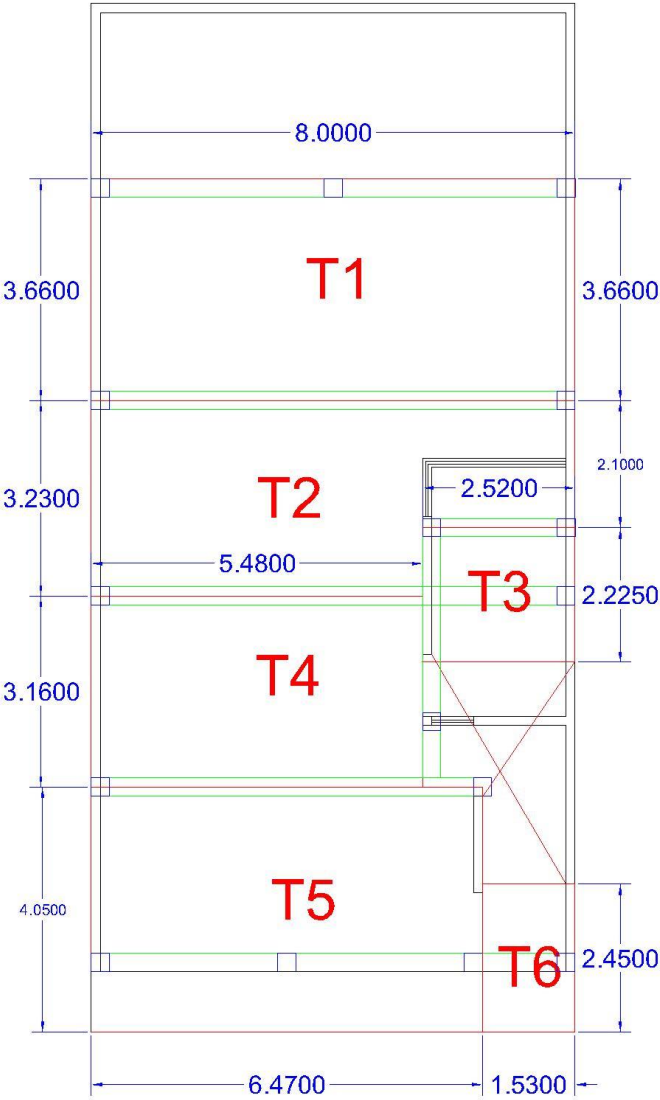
Distribución de tableros en planta baja (acotaciones en metros).
